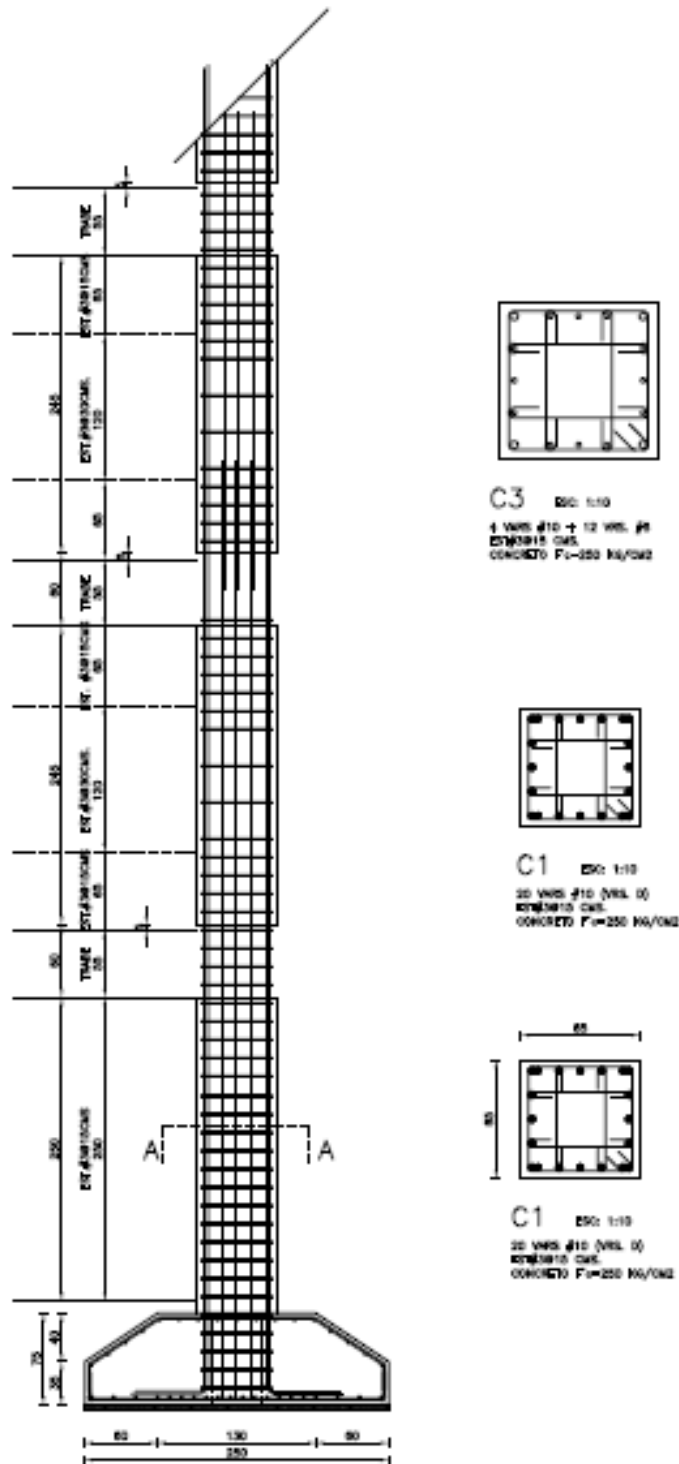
Detalle de elevación en armado tipo de columnas prototipo base fija
